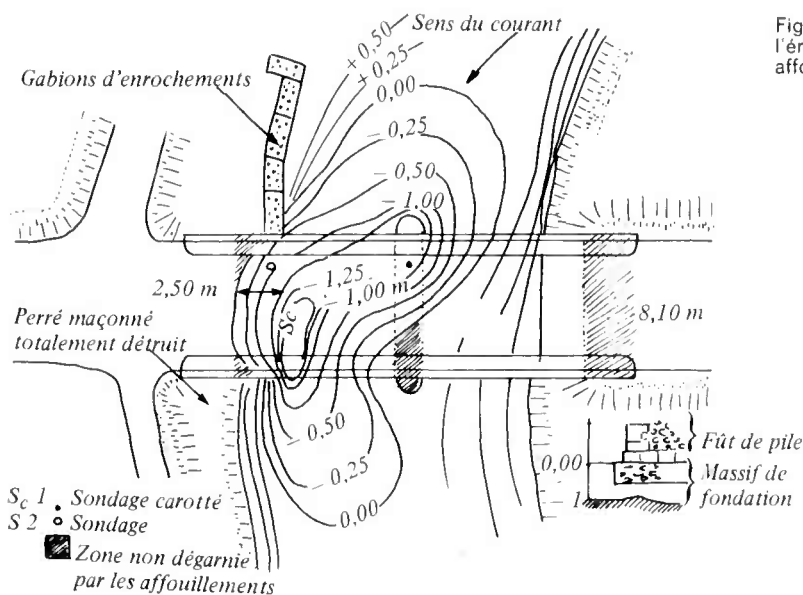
Pont de Régereau. Plan de l'érosion des fonds et des affouillements des appuis.
